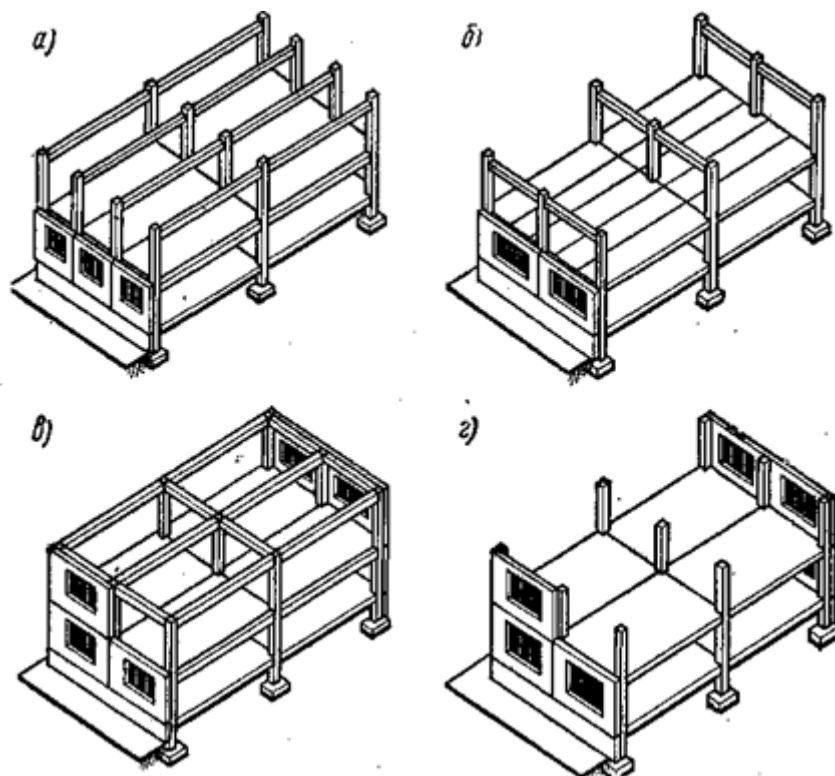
Конструктивные схемы каркасных зданий: а — с продольным расположением ригелей; б — то же, с поперечным; в — то же, с перекрестным; г — безригельное решение
